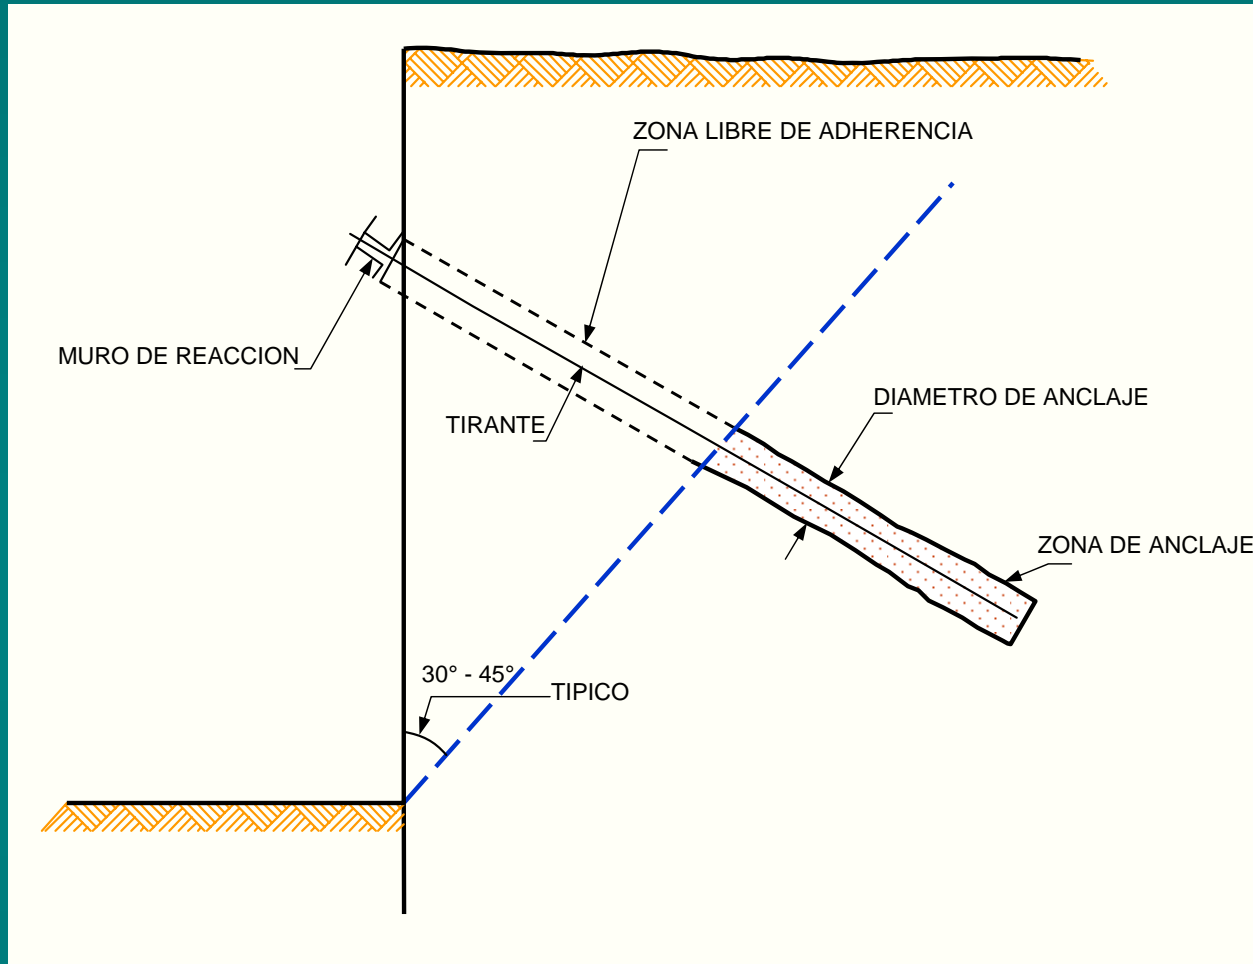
ZONA DE ANCLAJE Y ZONA LIBRE DE ADHERENCIA
